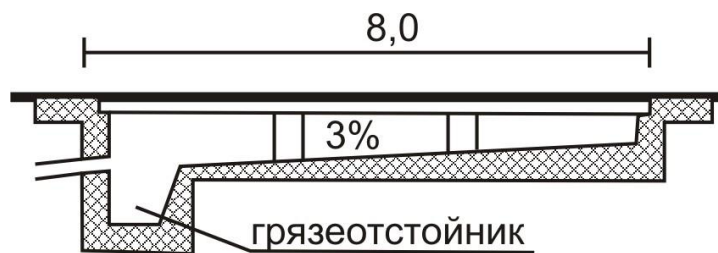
Яма под моечным стендом (продольный разрез пола)
